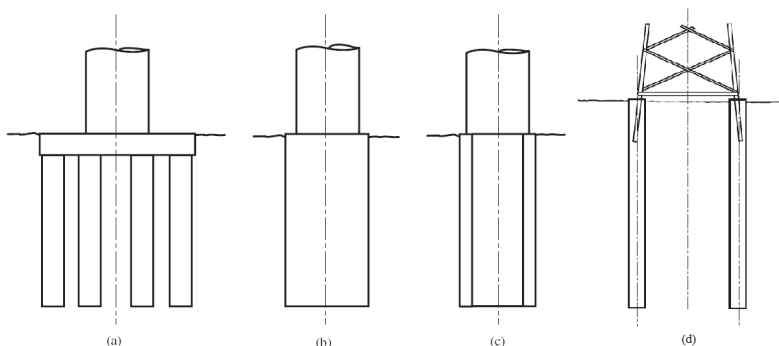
Tipos de fundações multi e mono pilares [Burton01]: a) Fundação multi pilar; b) Fundação mono pilar sólido; c) Fundação mono pilar oco; d) Fundação para torres de aço entrelaçadas.
